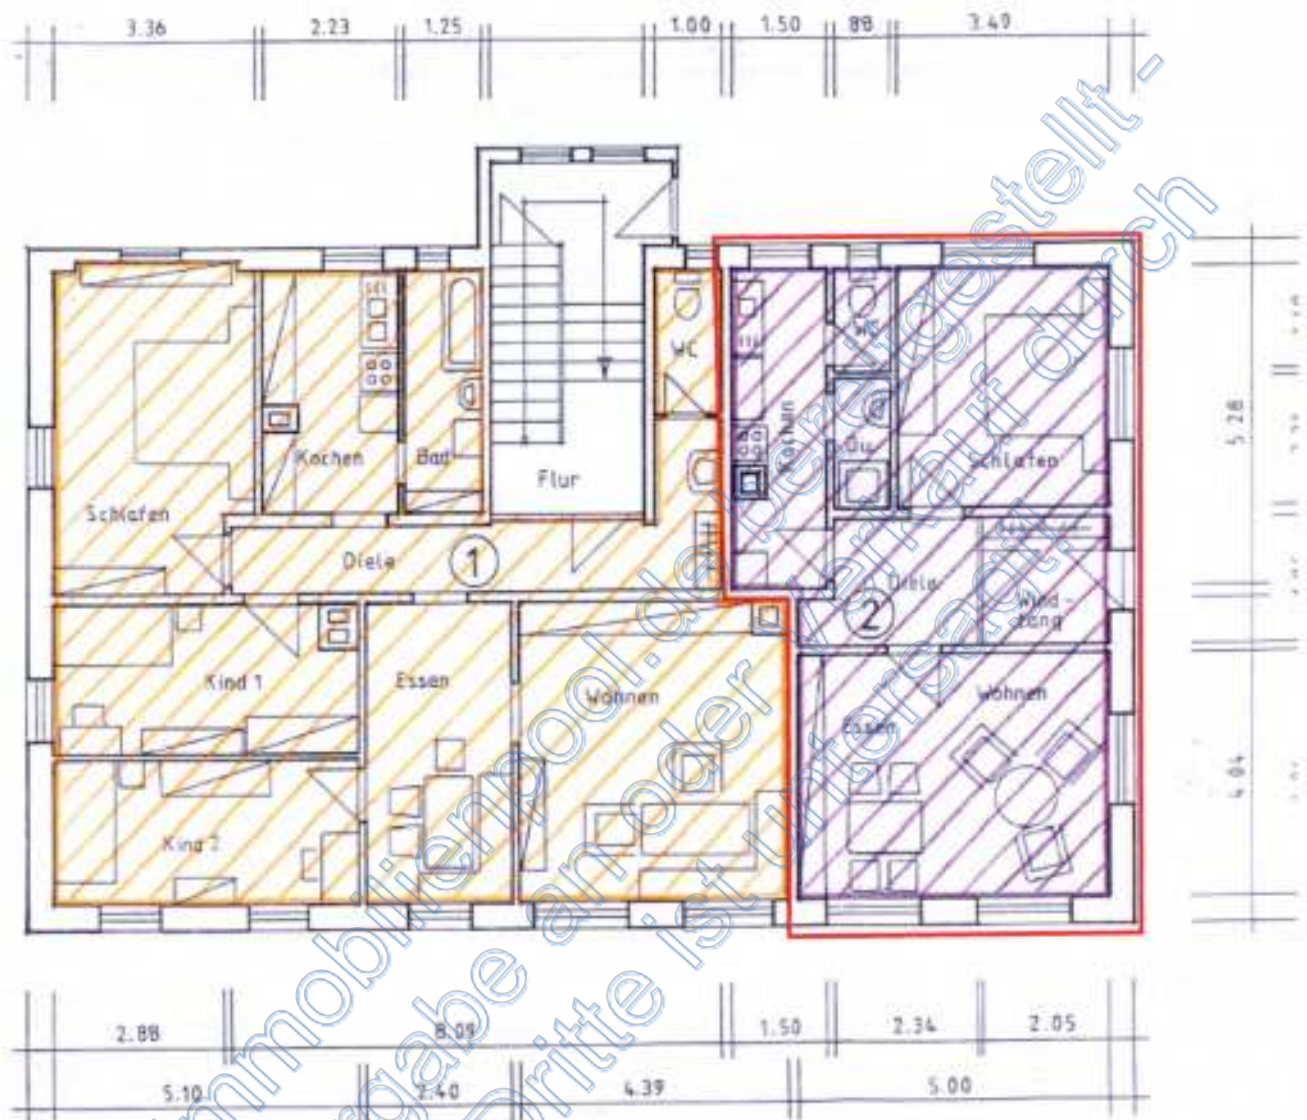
Grundriss EG (ohne Maßstab), Detail Sondereigentum Wohnung Nr. 2; Quelle: Teilungspläne aus der Teilungserklärung UR Nr. 1034/1989 vom 20.12.1989, Grundakte zu Grundbuch Blatt 20607, Roteintragung d.d. SV
